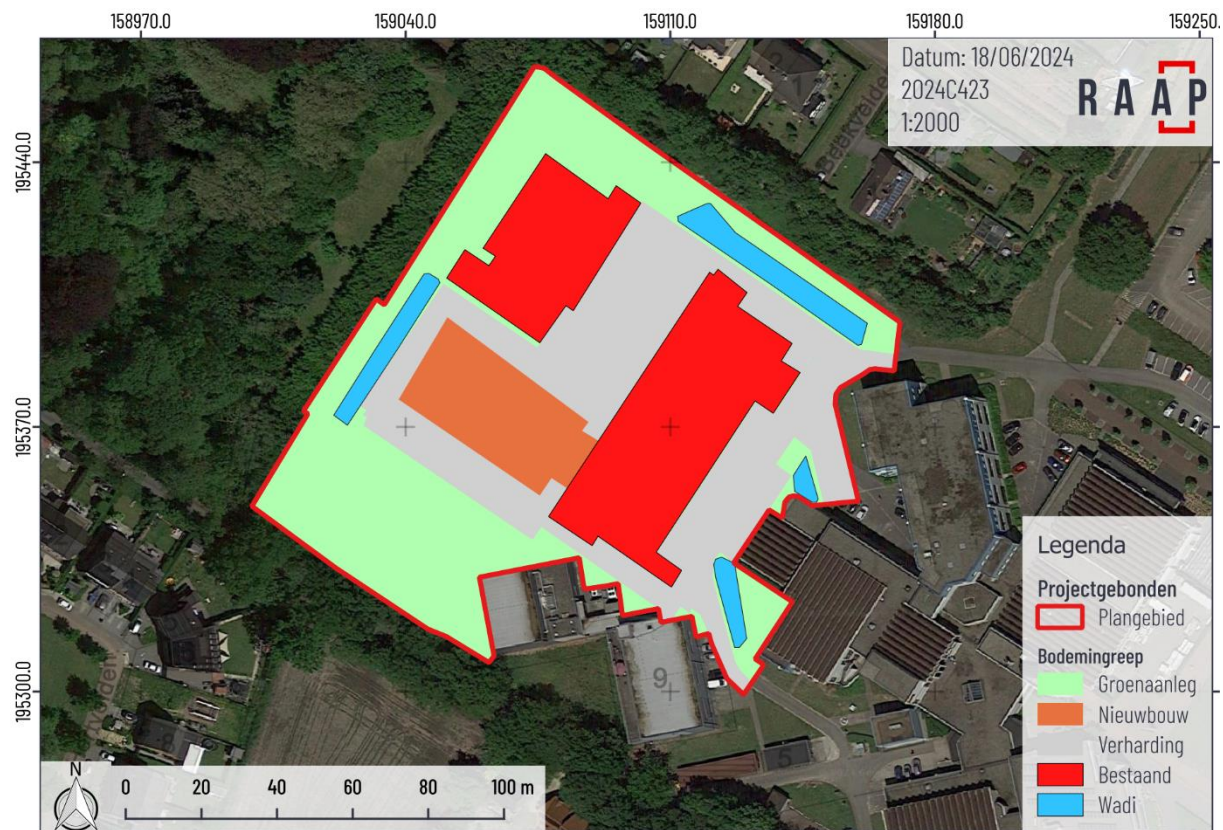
Inplantingsplan van de geplande werken (bron: opdrachtgever).
